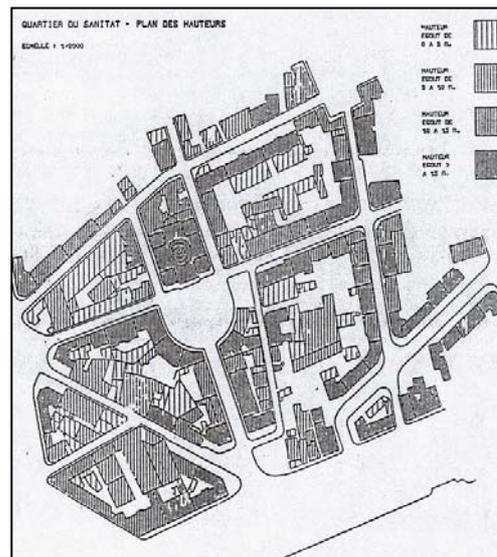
; Quartier du Sanitat – Plan des hauteurs (échelle 1/2000)
